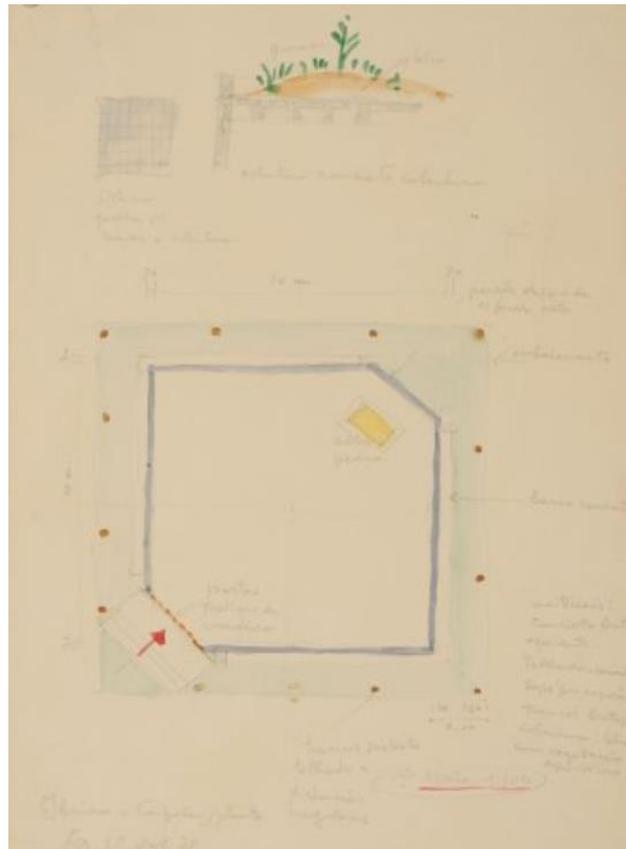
planta de la Capilla Santa María dos Anjos, 1978, archivo Instituto Bardi
